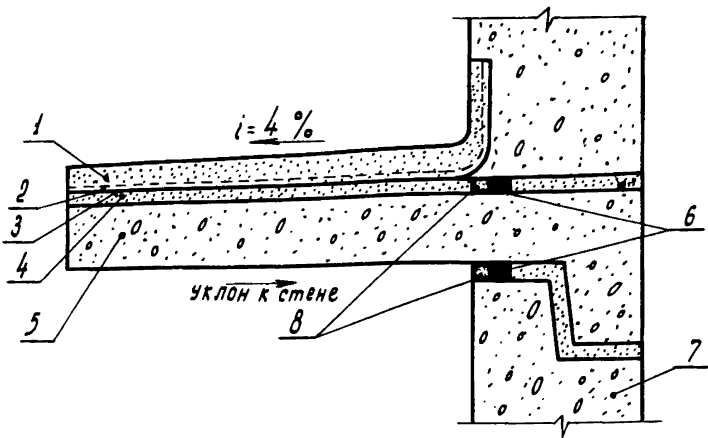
Герметизация сопряжения балконной плиты со стеновыми панелями и ликвидация обратного уклона балконной плиты: 1 - цементная стяжка, 2 - арматурная сетка 50x50 мм², 3 - слой гидроизоляции, 4 - цементная стяжка, 5 - железобетонная балконная плита, 6 - мастика УМС-50, 7 - стеновая панель, 8 - гидрофобный цементный раствор.
